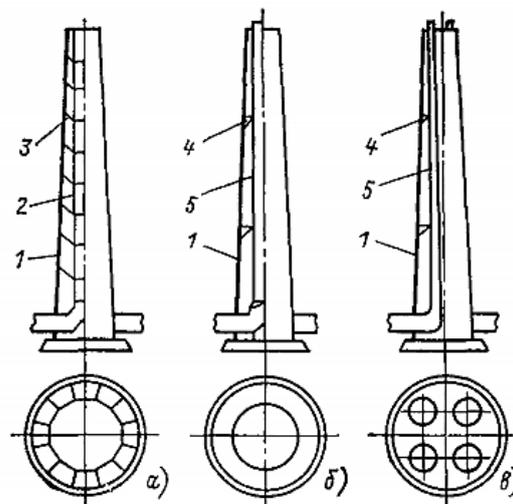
Дымовые трубы с отдельными газоотводящими стволами цилиндрической формы.
